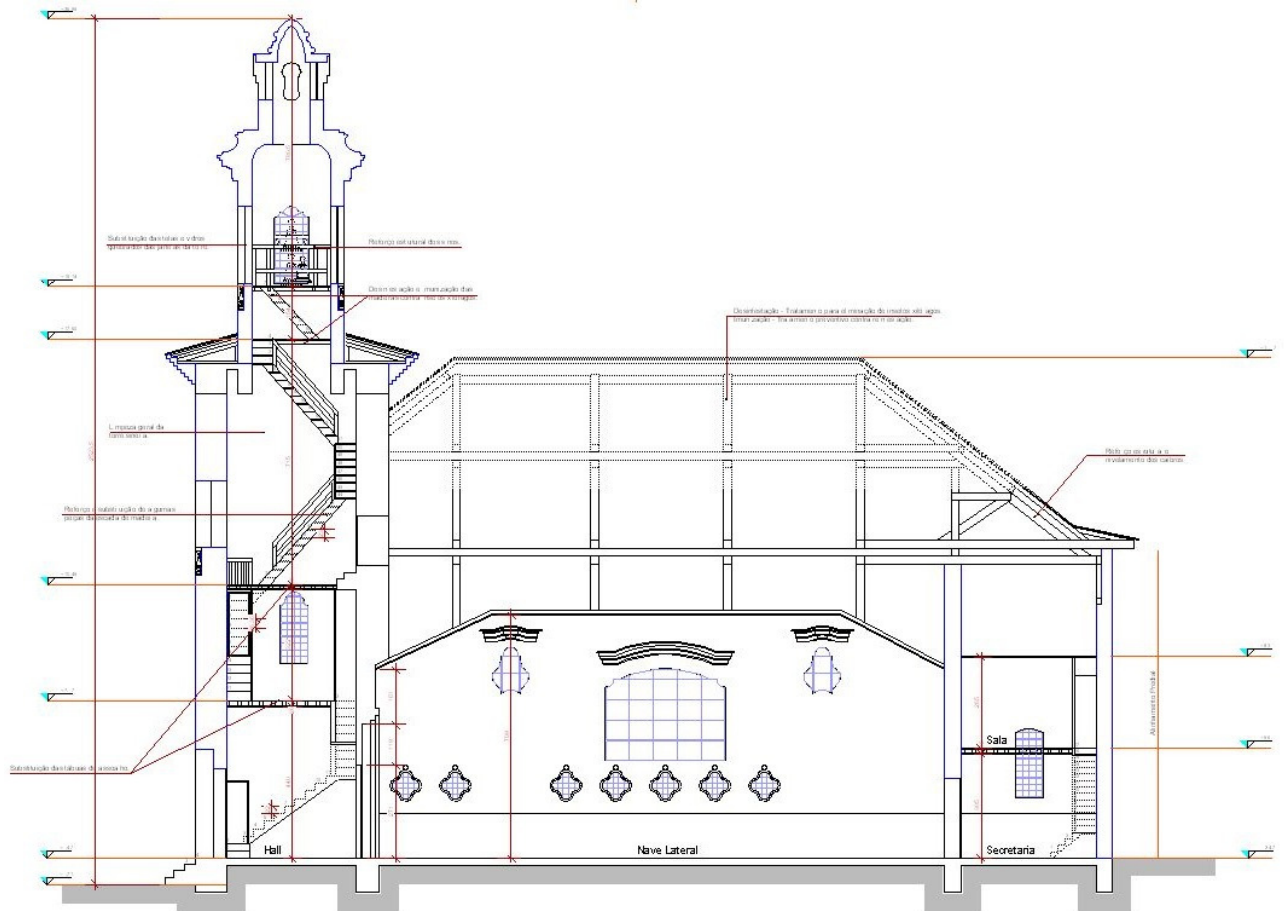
g: Igreja de Nossa Senhora do Rosário de São Benedito – croqui: corte longitudinal da nave e campanário.
